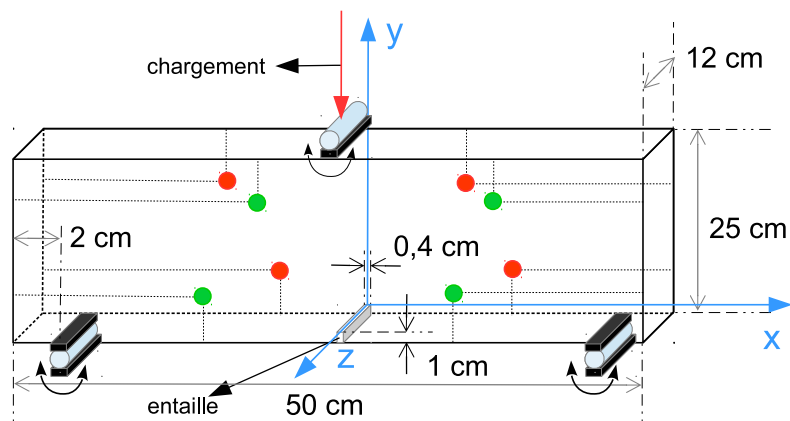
Schéma et dimension des poutres p1-x pour la flexion 3 points.
